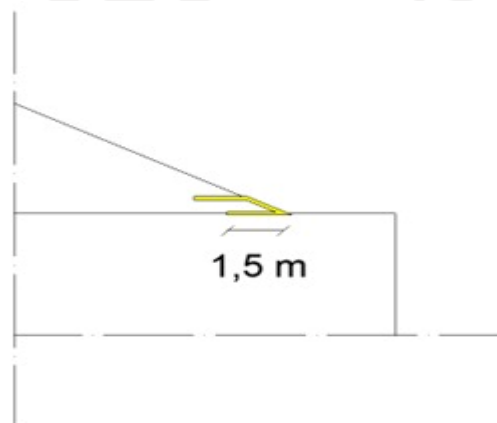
Detail Panjang *Overlapping* Geotekstil Pada Timbunan 14m
